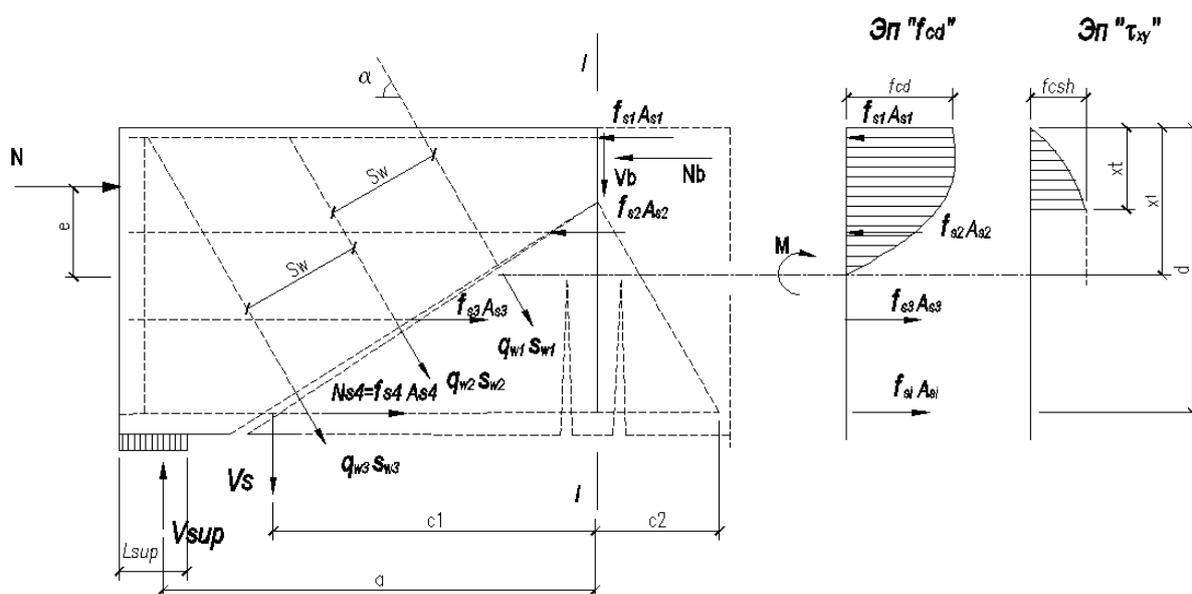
Расчетная схема к расчету прочности железобетонных колонн кругового сечения по сечениям, наклонным к продольной оси элемента
